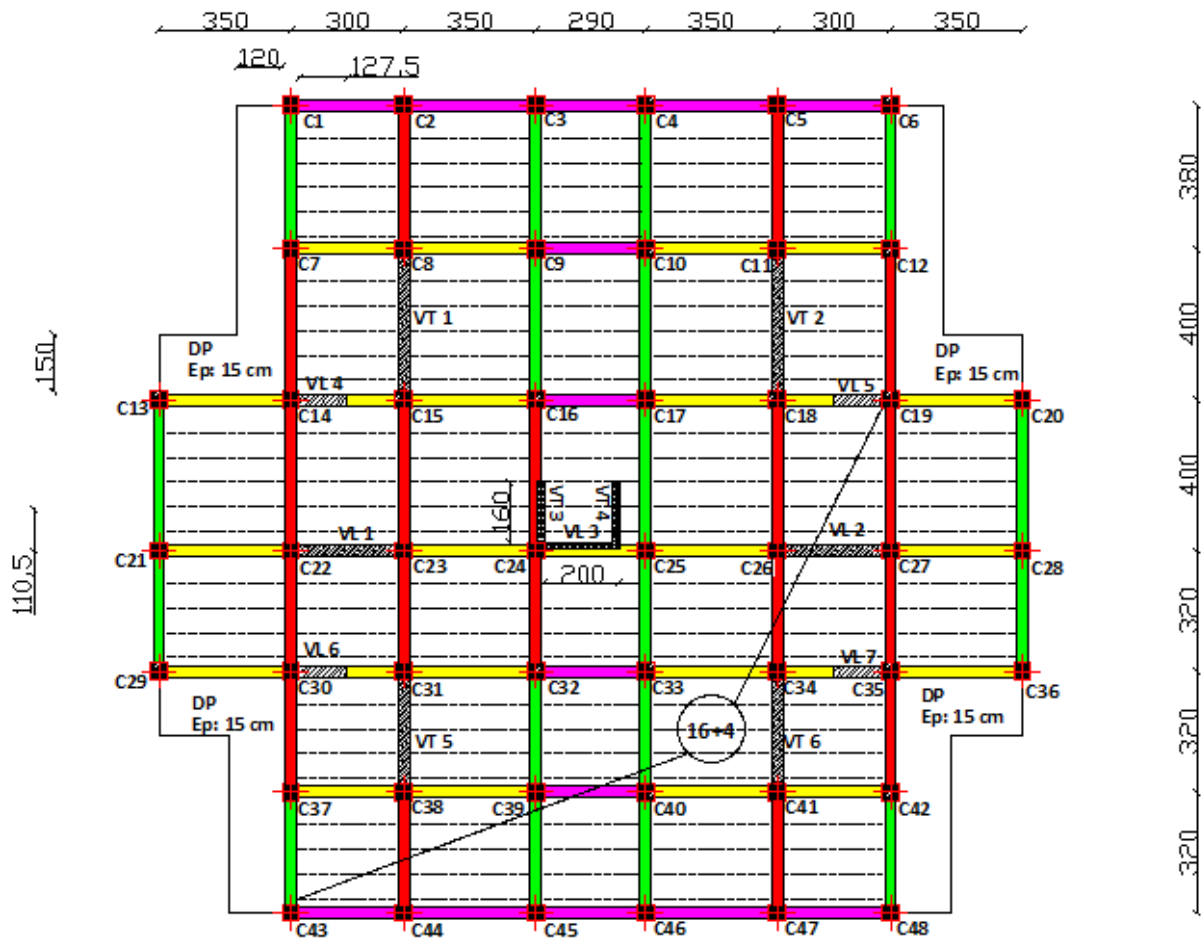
Figure montrant le groupe des poutres pour le ferrailage.
